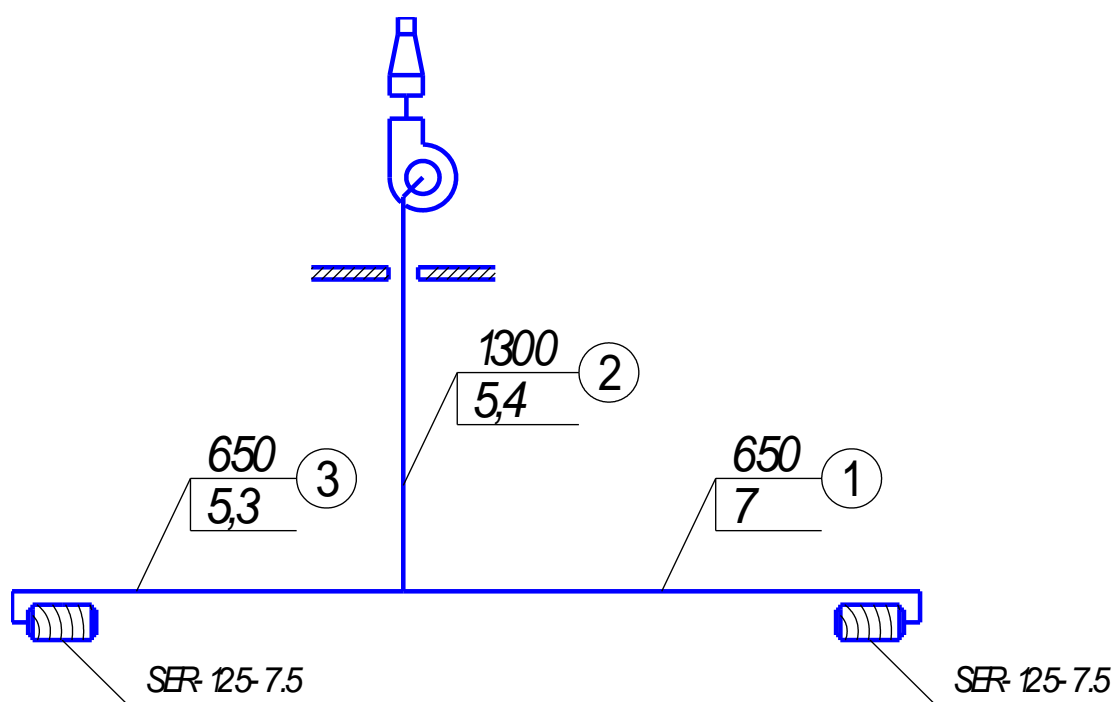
Расчетная схема местной вытяжной системы вентиляции
